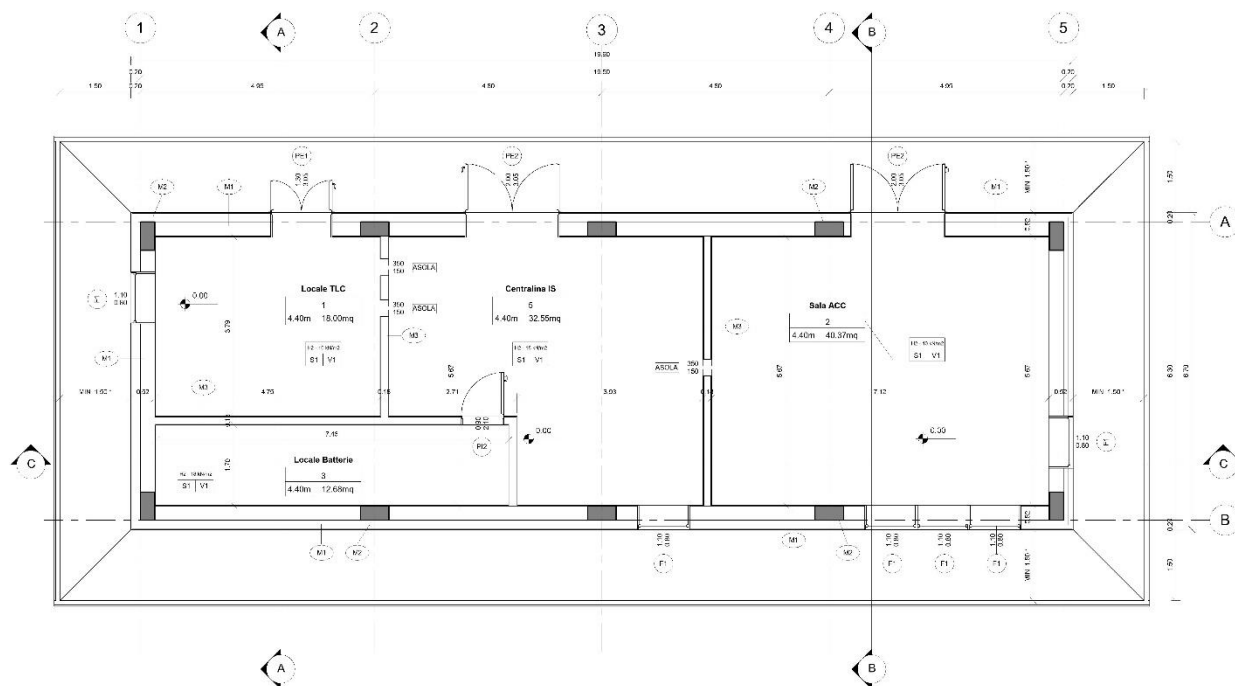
Pianta Architettonica Piano Terra – Layout T4_A
